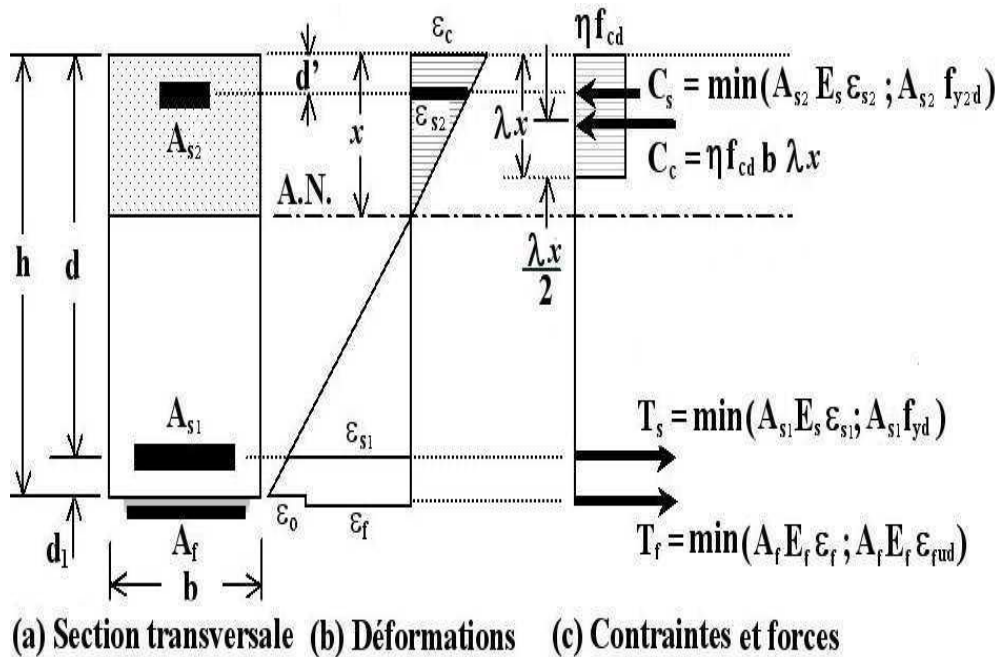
Représentation graphique de la section transversale d'une poutre en BA et renforcée par une plaque.
